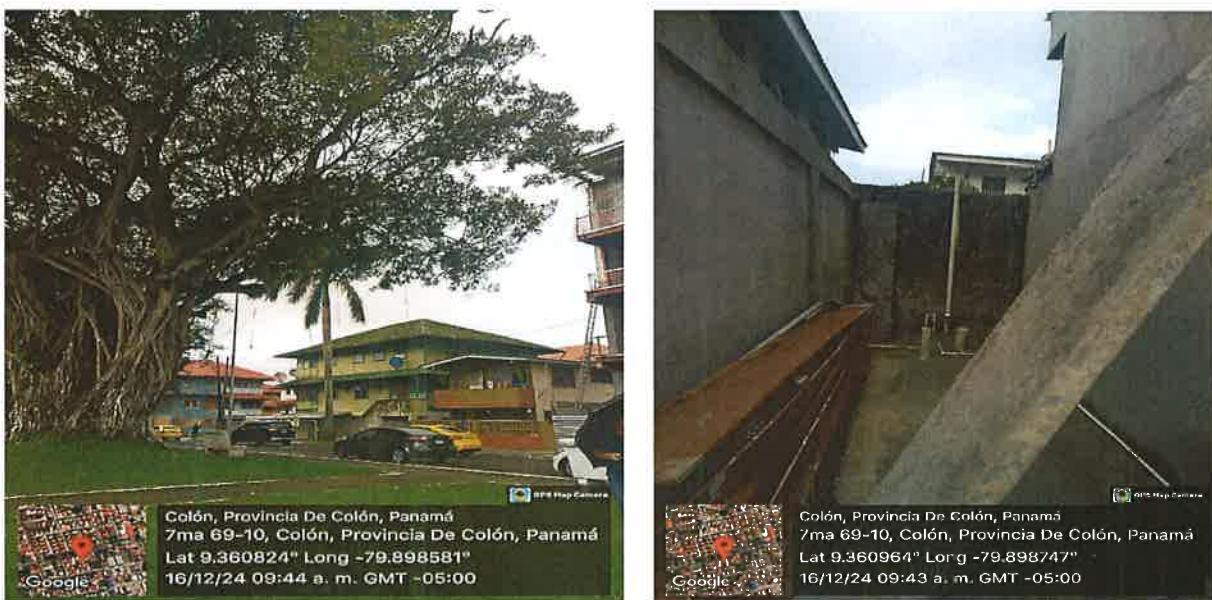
Vistas del área interna y externa del lago izquierdo del Proyecto de construcción, colindante con las viviendas y frente del Parque.
